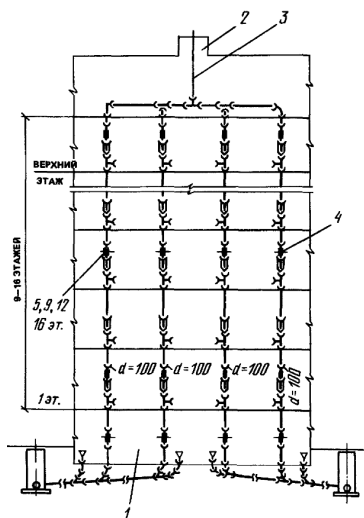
Схема объединения вентиляционных канализационных стояков в жилом здании: 1 — техническое подполье (подвальный этаж); 2 — вентиляционная шахта теплого чердака; 3 — общий вытяжной стояк; 4 — этажные стояки в санитарно-технических кабинках
